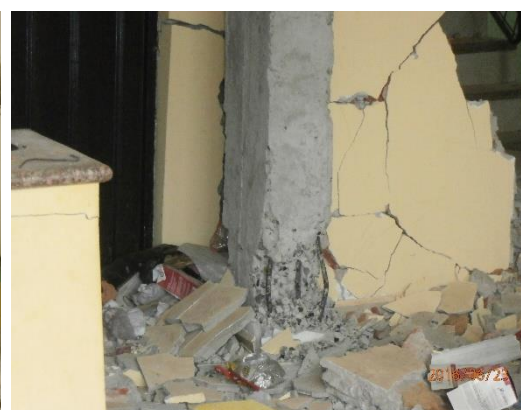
Desprendimiento de recubrimiento en la conexión y corte en mampostería
